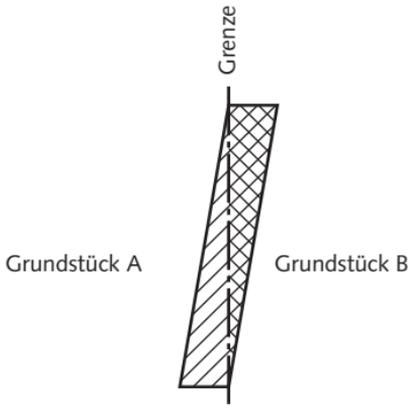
Zum Teil übergebaute Mauer (Grundriss)
